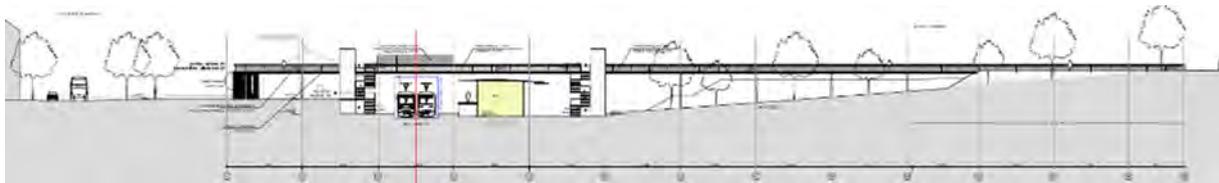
Coupe longitudinale de la passerelle (BMN, 2017)
